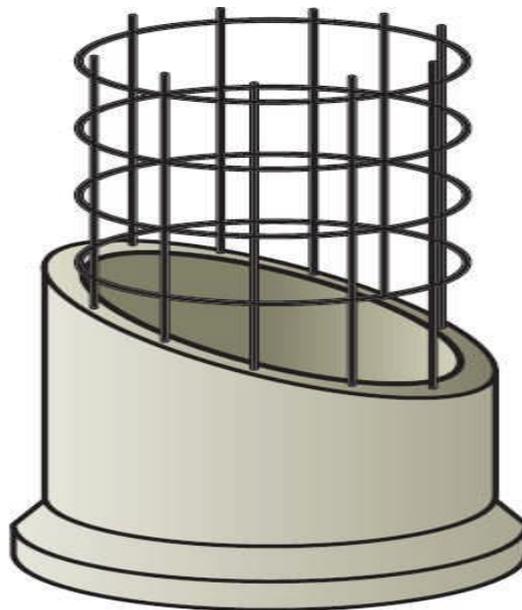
Principe d'armature d'un tuyau en béton armé.
